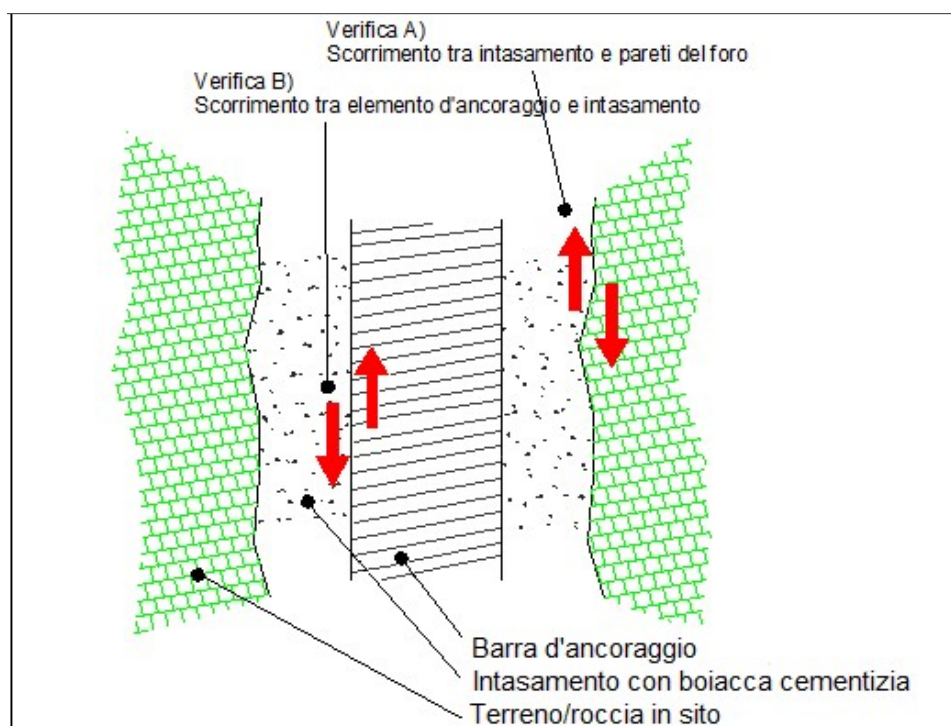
Verifiche rispetto allo sfilamento dell'ancoraggio.
